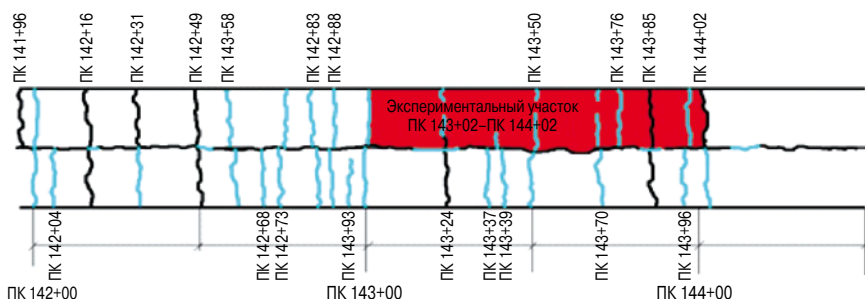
Схема распространения поперечных и продольных трещин на участке автомобильной дороги Чита–Хабаровск на 365 км (ПК 142+00 – ПК 144+02). Обследование 2011 г.
